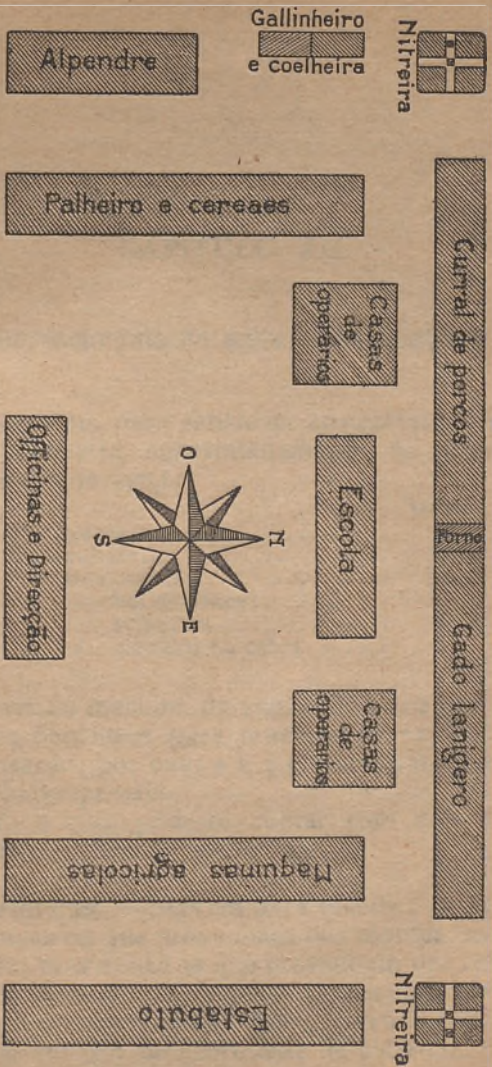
PLANO DE DISPOSIÇÃO DOS ANNEXOS DE UMA CASA DE LAVOURA
